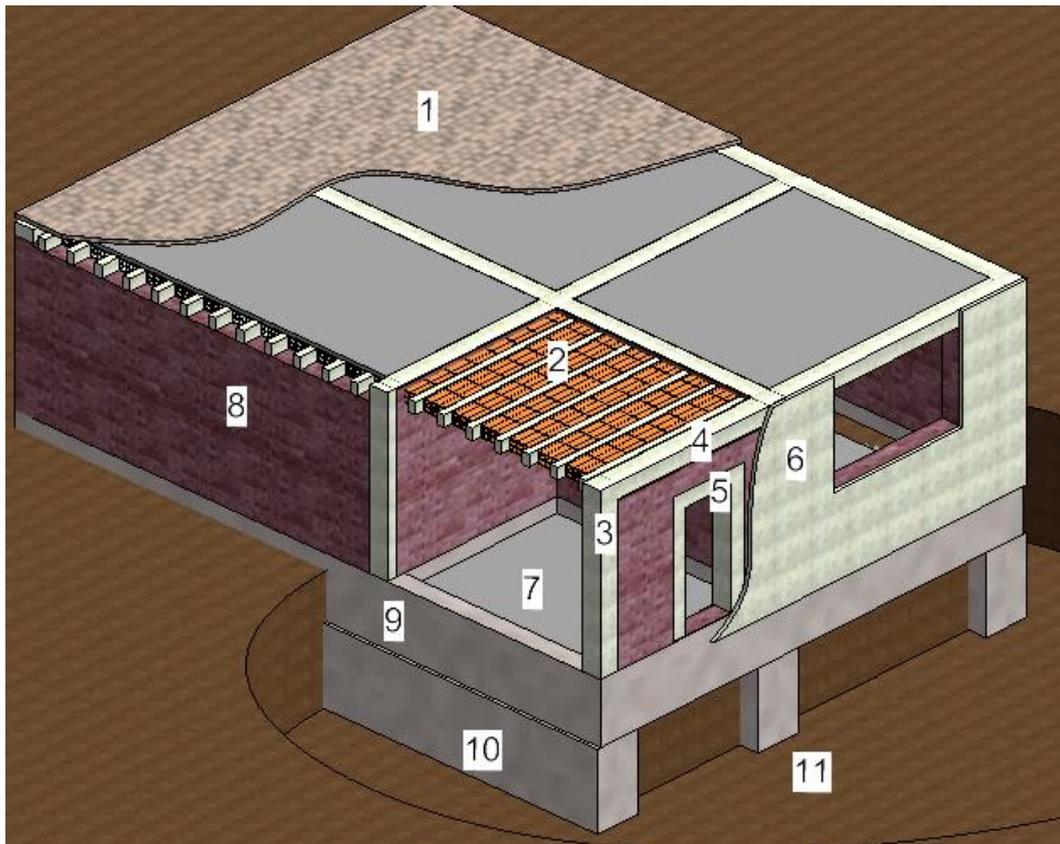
Elementos de una vivienda de Albañilería Confinada.
